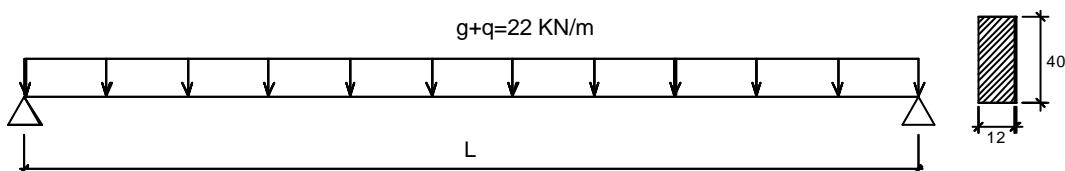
Esquema estrutural da viga do exemplo 5
